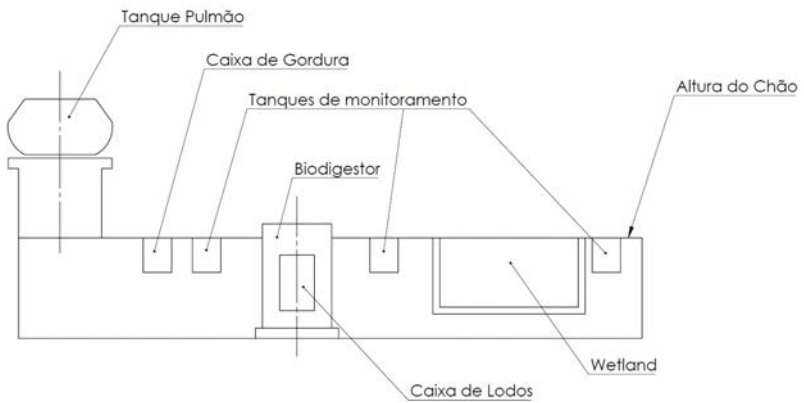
Perfil da planta do protótipo - Nome de cada elemento
